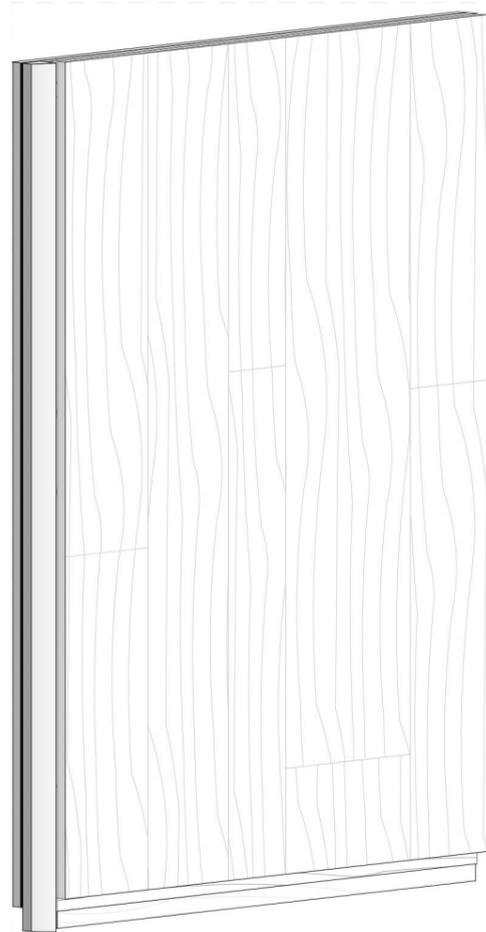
Muro ciego de panel diseñado. Fuente: Autoría propia.
